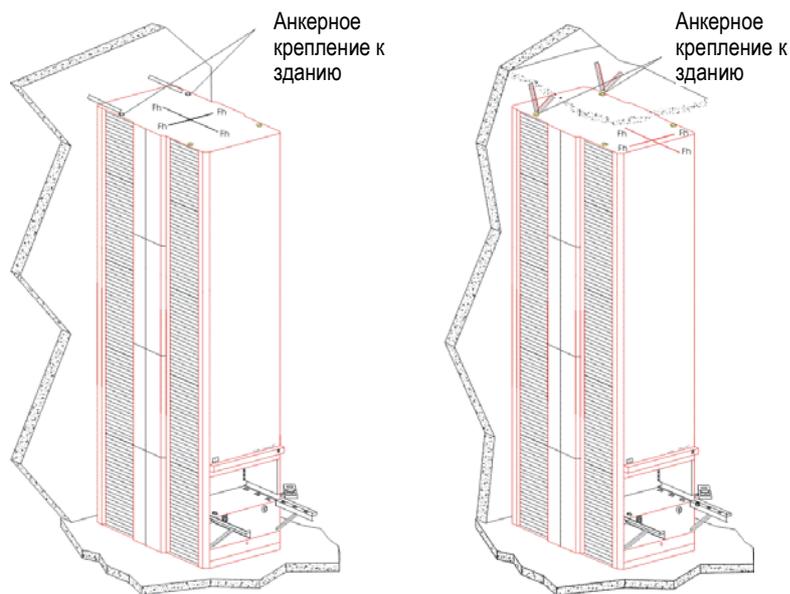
Примеры креплений: анкерное крепление к потолочному перекрытию здания
